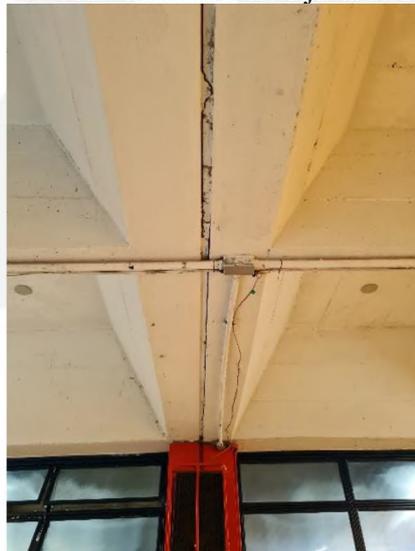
Infiltração devido falha de impermeabilização da cobertura.
